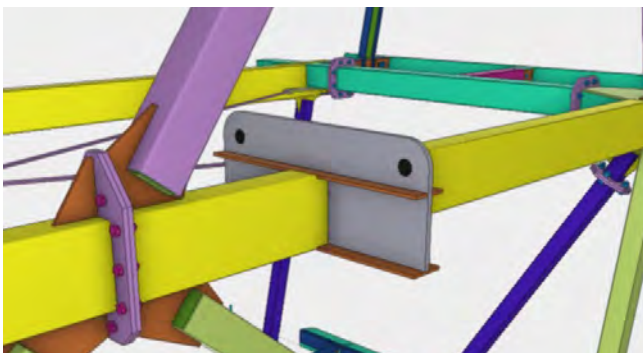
Detalle de nudo para izado por un punto. Modelo BIM de fabricación.
